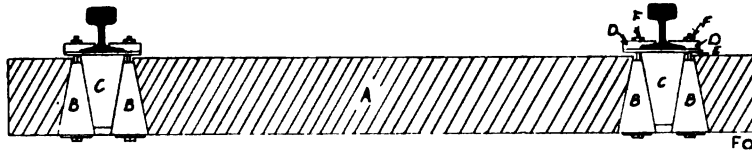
Schwelle aus Stampfbeton ohne Einlage.
